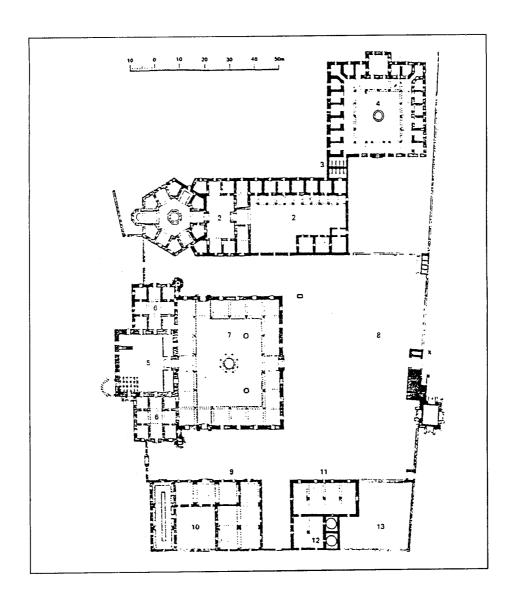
مسقط أفقي لمسجد بايزيد الأول في برجامه (عن : ايفردى)
